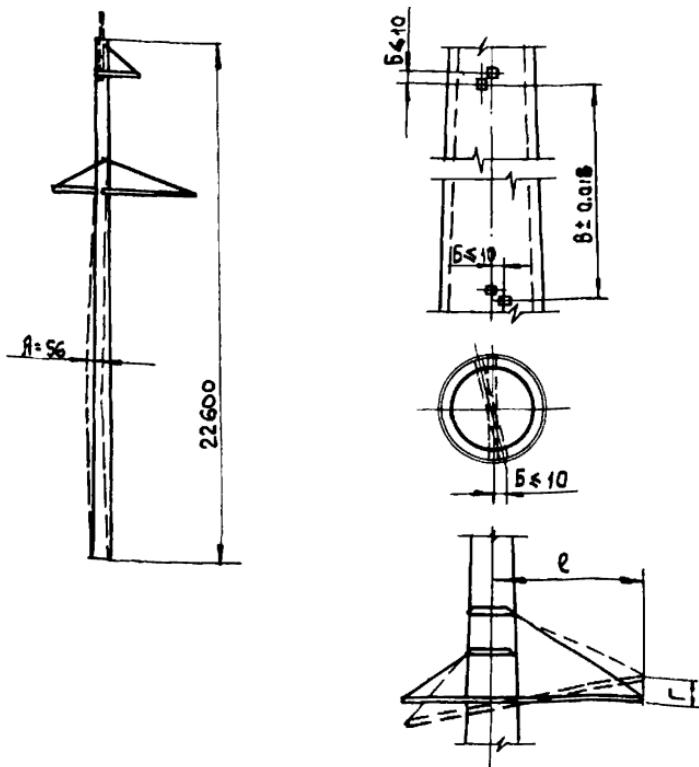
Нормы и допуски на сварку опор
